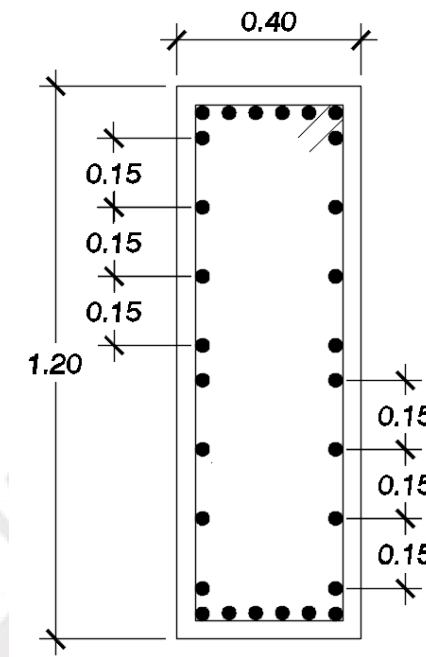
Barras de refuerzo de la viga de cimentación: VC-7 (40X120)
